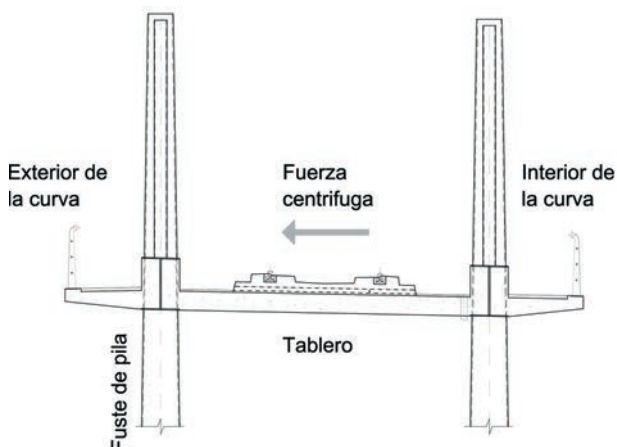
Pórtico formado por los fustes de una pila y el tablero del puente
